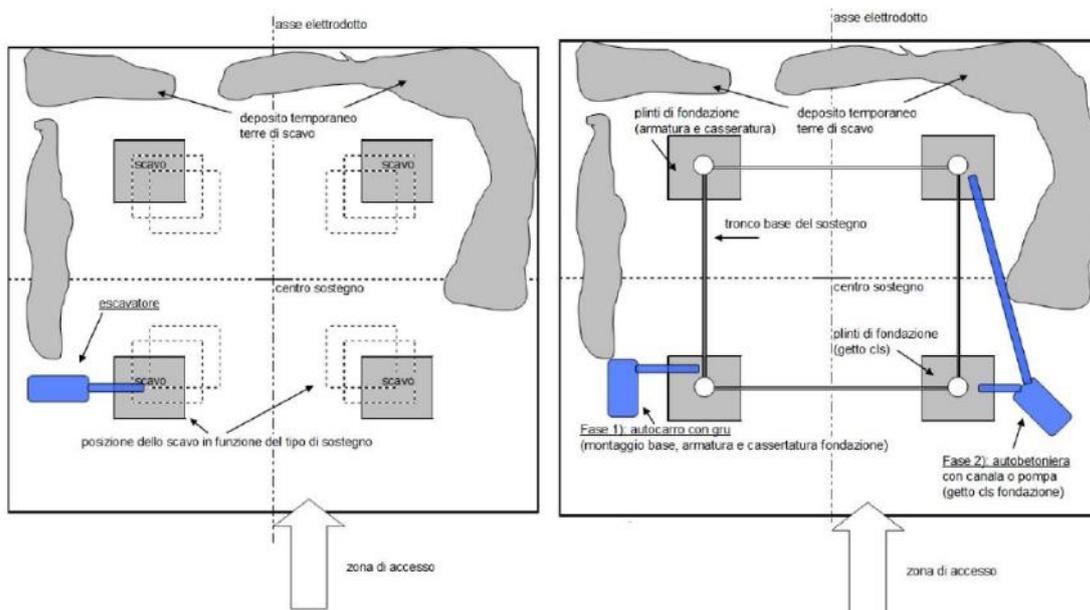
Planimetria dell'Area centrale – Tipologico
